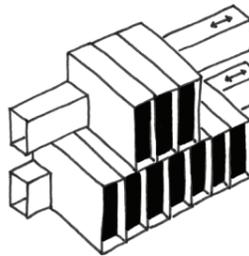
Räumliche Grundstruktur mit Erschließungsgang auf jeder 2. Ebene
